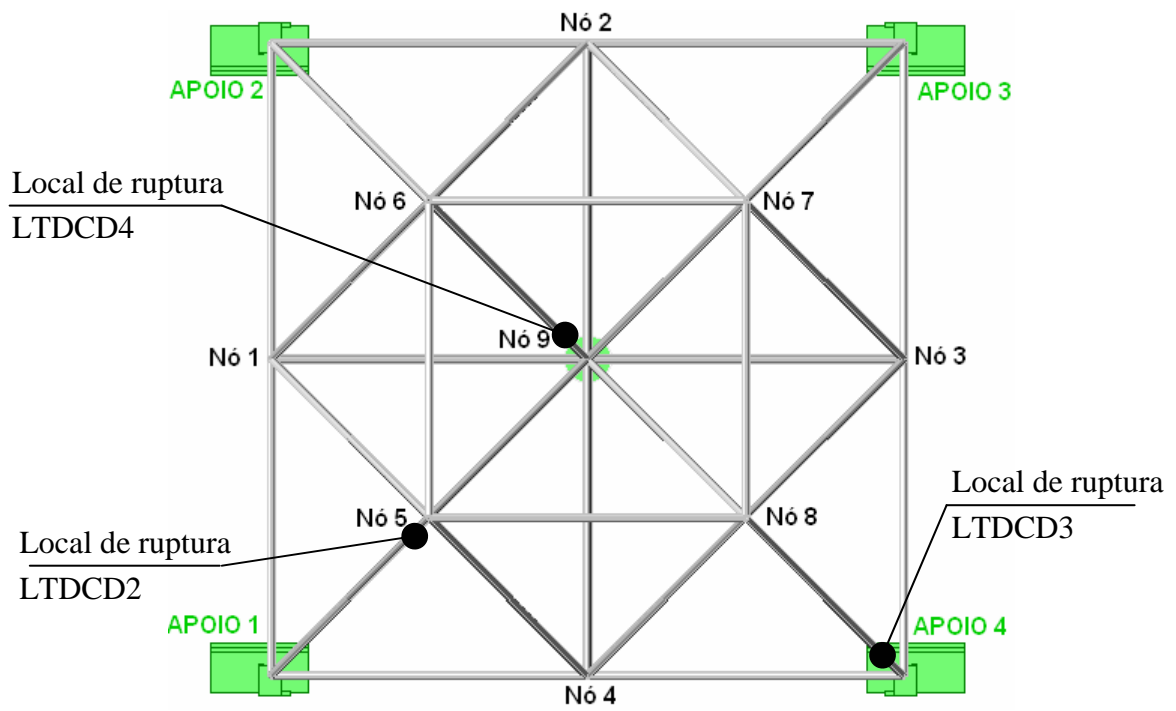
Planta de localização das barras rompidas no ensaio dinâmico - LTDCD
